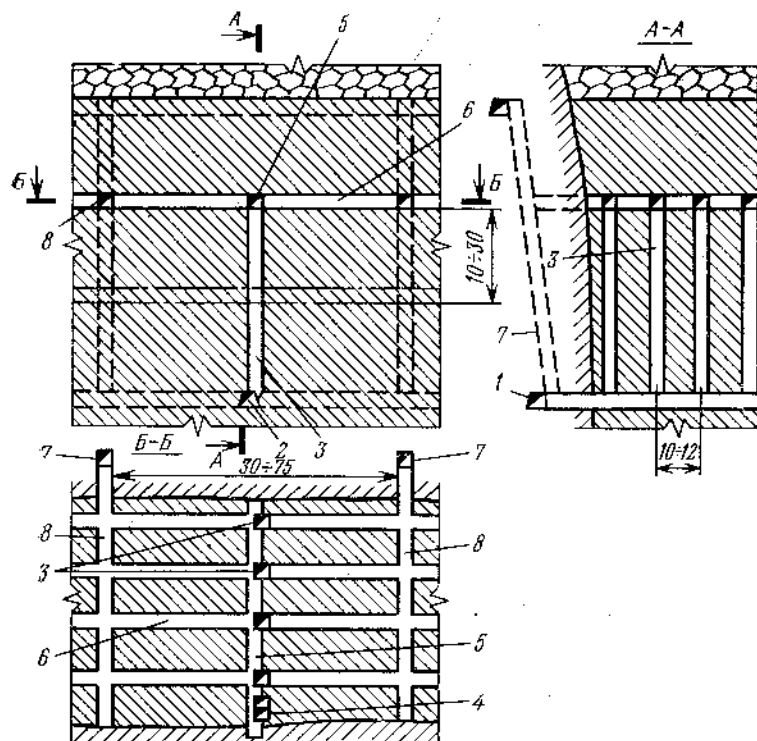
Подготовка блока при подэтажном обрушении с прямым скреплением руды
